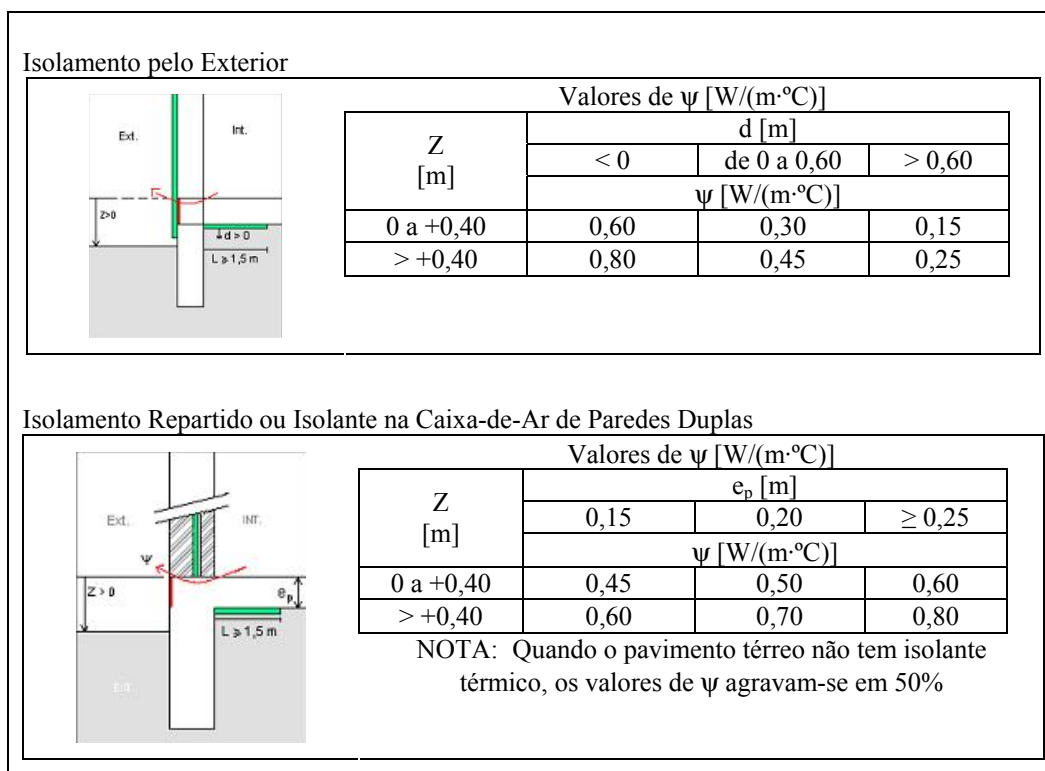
Comparação dos valores de ψ da ligação fachada com o pavimento térreo na situação de isolamento pelo exterior e isolamento repartido [4]
